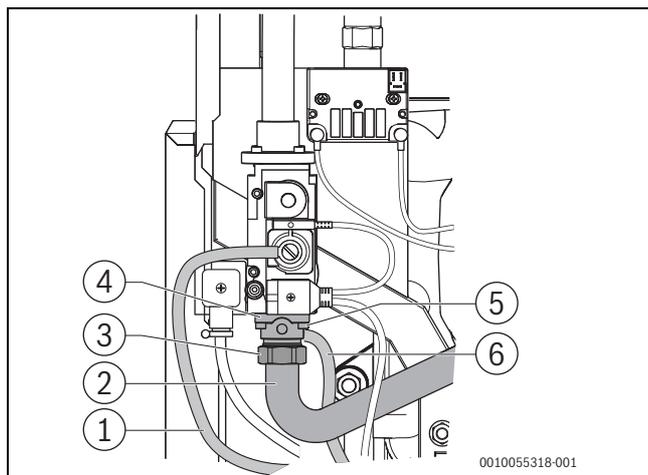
Smontaggio del diaframma del gas (caldaie di dimensione 75; 100 kW)
